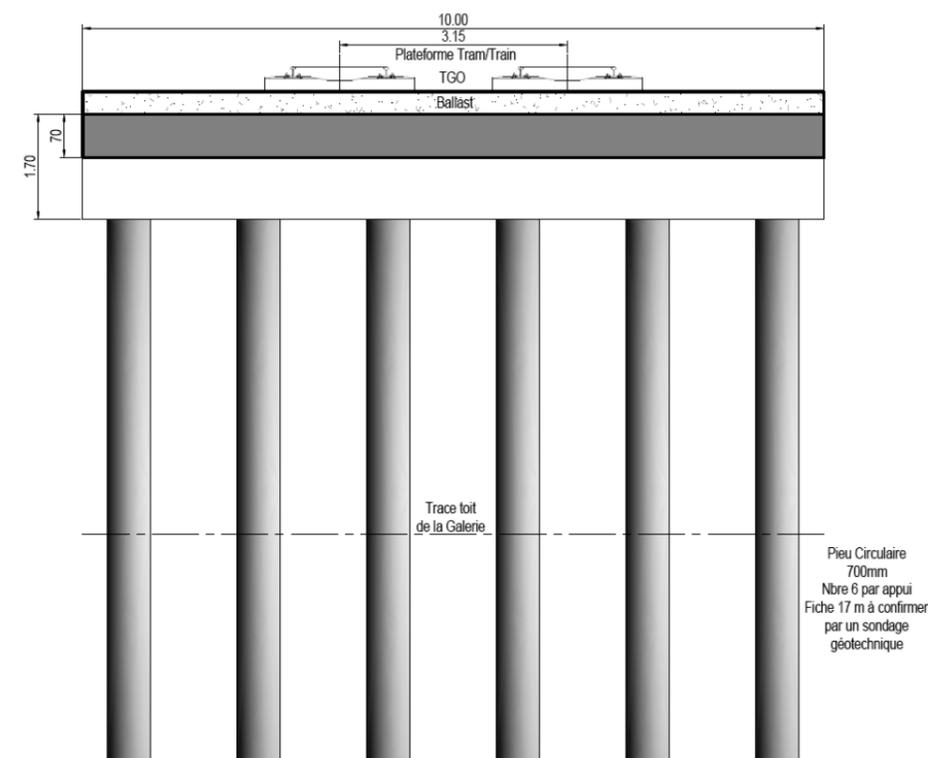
Ouvrage de franchissement de la galerie (coupe B)
